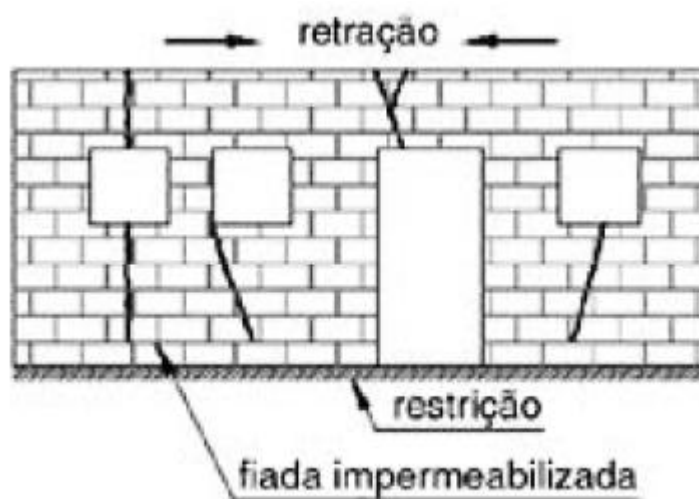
Restrições à retração: intertravamento pela laje inferior.
